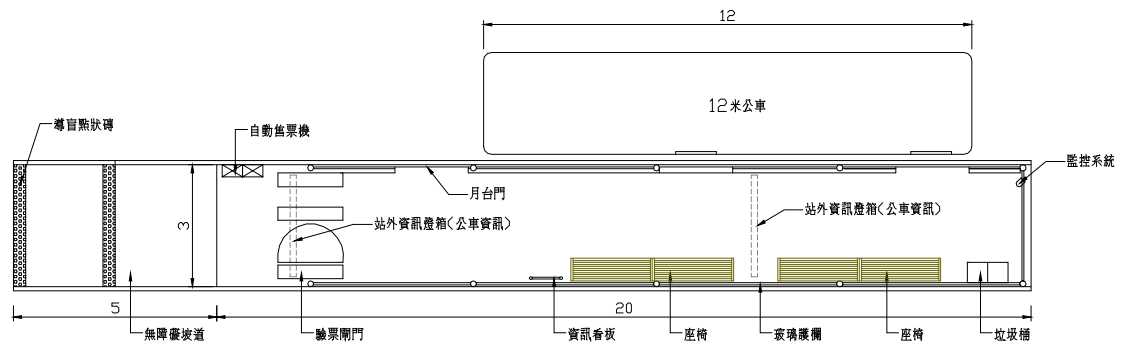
BRT 車站站體(3 公尺寬)平面配置示意圖
